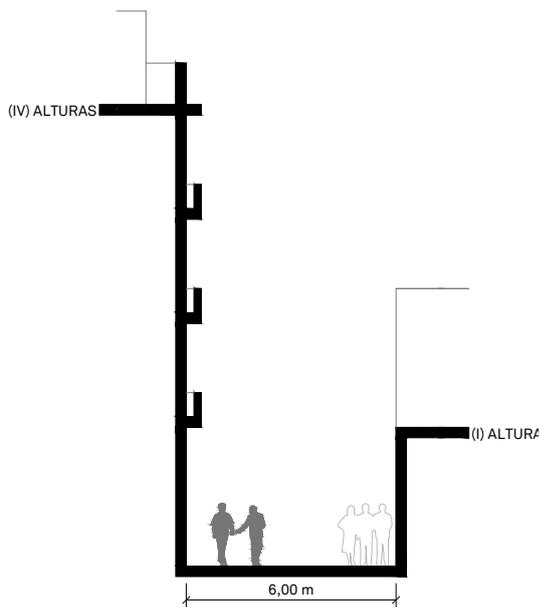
y 135. Calle Badajoz. Elaboración propia.
